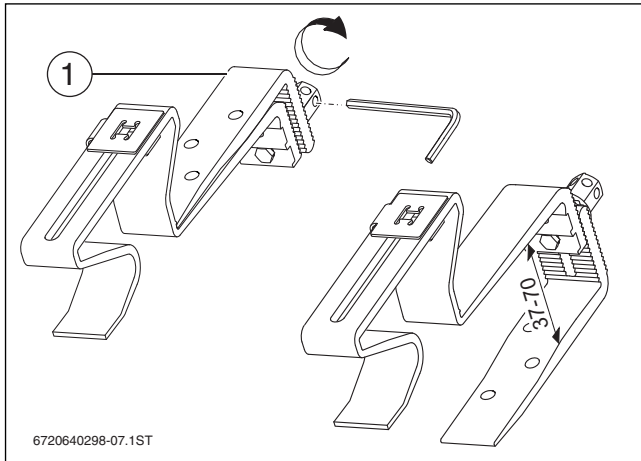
Dachhaken-Unterteil drehen, Maße in mm
